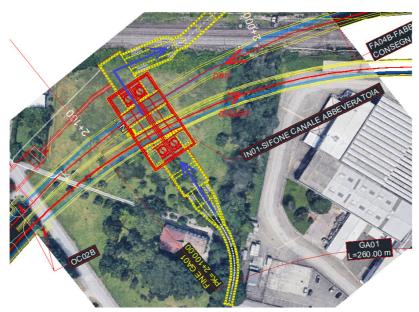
PLANIMETRIA SU IMMAGINE FOTOGRAFICA AEREA
